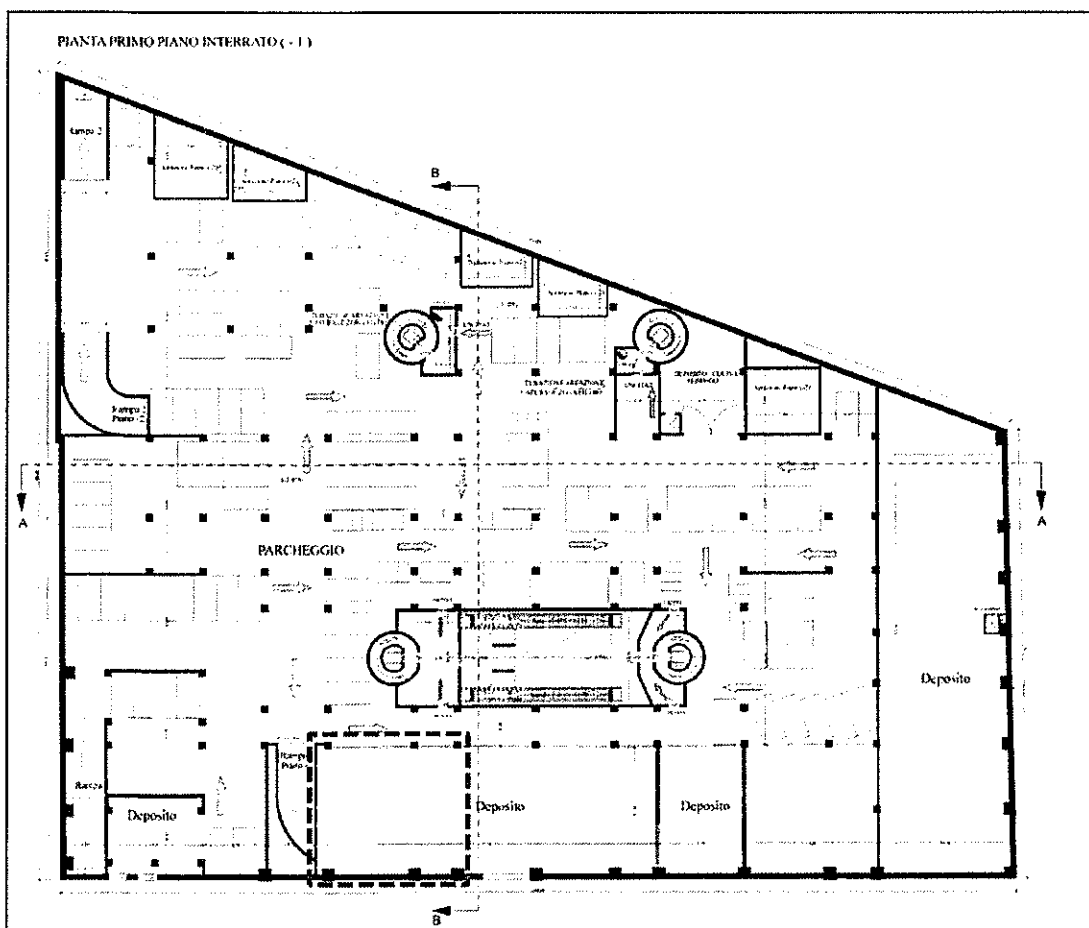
Progetto del piano primo interrato estratto dalla tavola allegata al PdC n. 59/2013.
